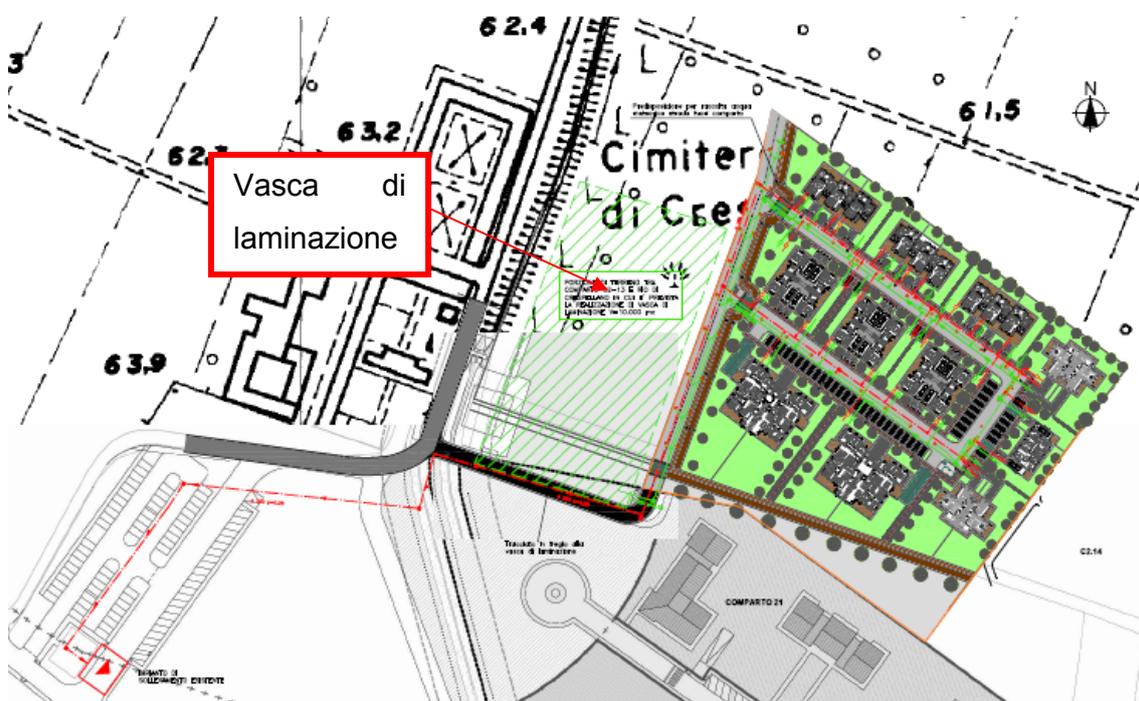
Planimetria del contesto. Evidenziato il comparto in attuazione e l’area di variante
